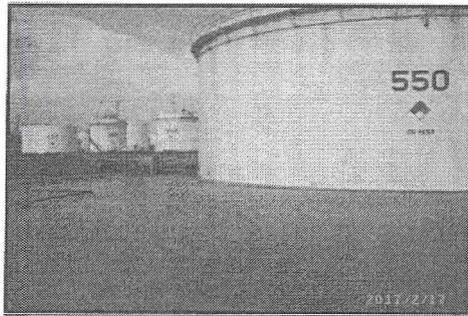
FOTO XIII: Tanque NL 550, muro y piso impermeabilizado.
